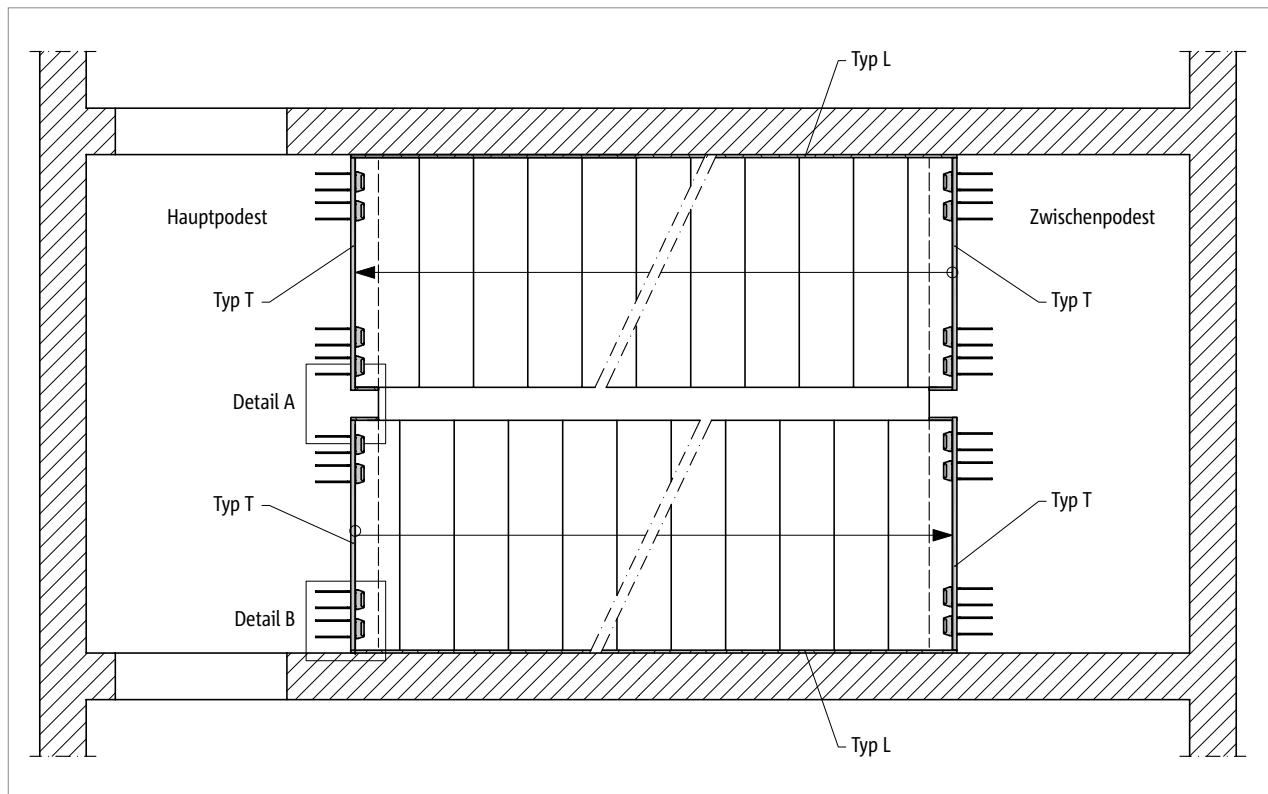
Tronsole® T: Elementanordnung im Grundriss
